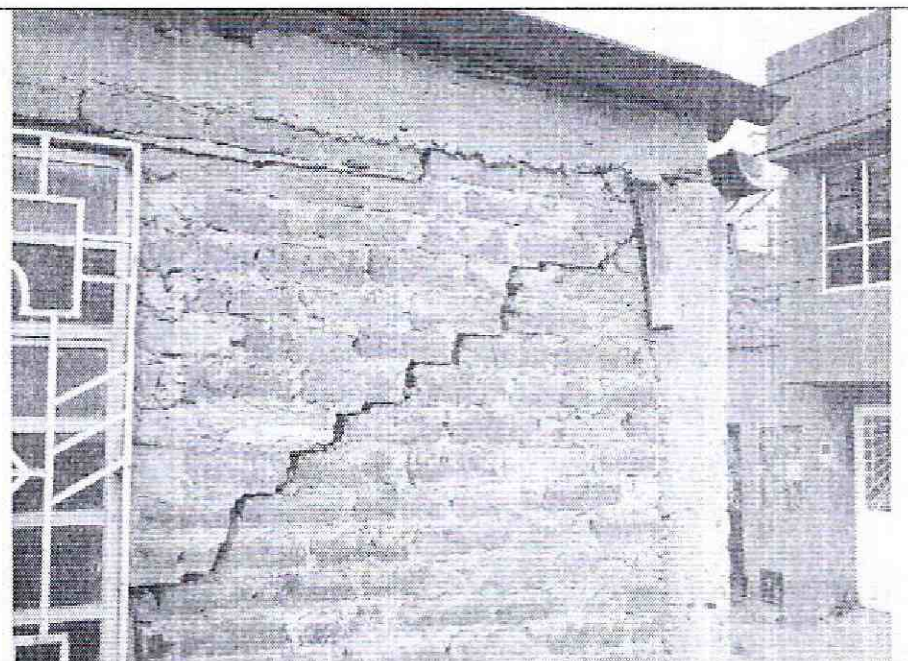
y 6. Costado sur oriental del predio. Agrietamiento en sentido diagonal en muro, separación unidades de mampostería, pérdida de recubrimiento y exposición de las barras de refuerzo de los elementos de confinamiento
